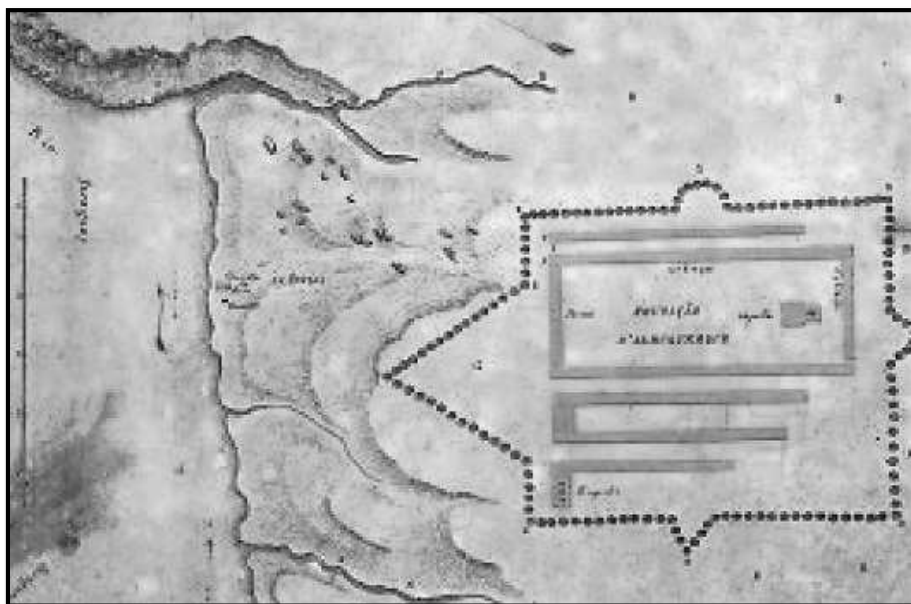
Planta do Novo Forte de Coimbra, extremo a esquerda a paliçada em madeira do ano de 1775 e a direita da Muralha da Fortificação erigida em 1797.
